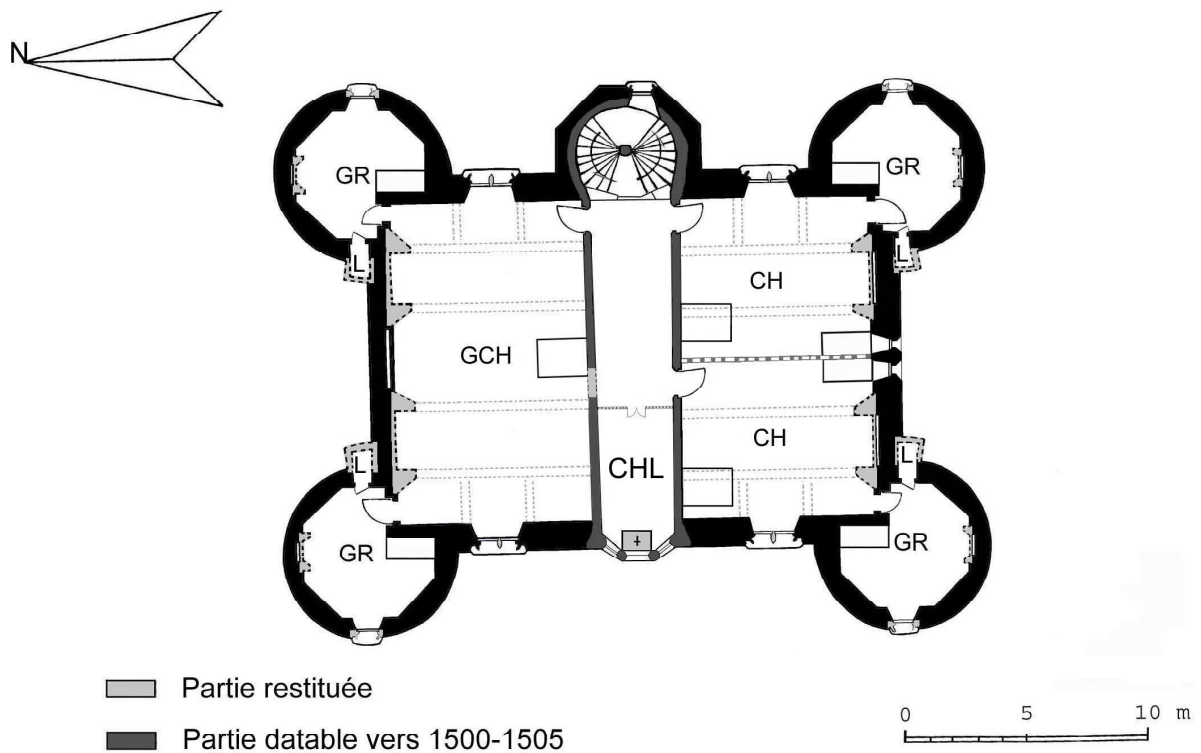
Martainville. Plan restitué du premier étage vers 1500-1505.
